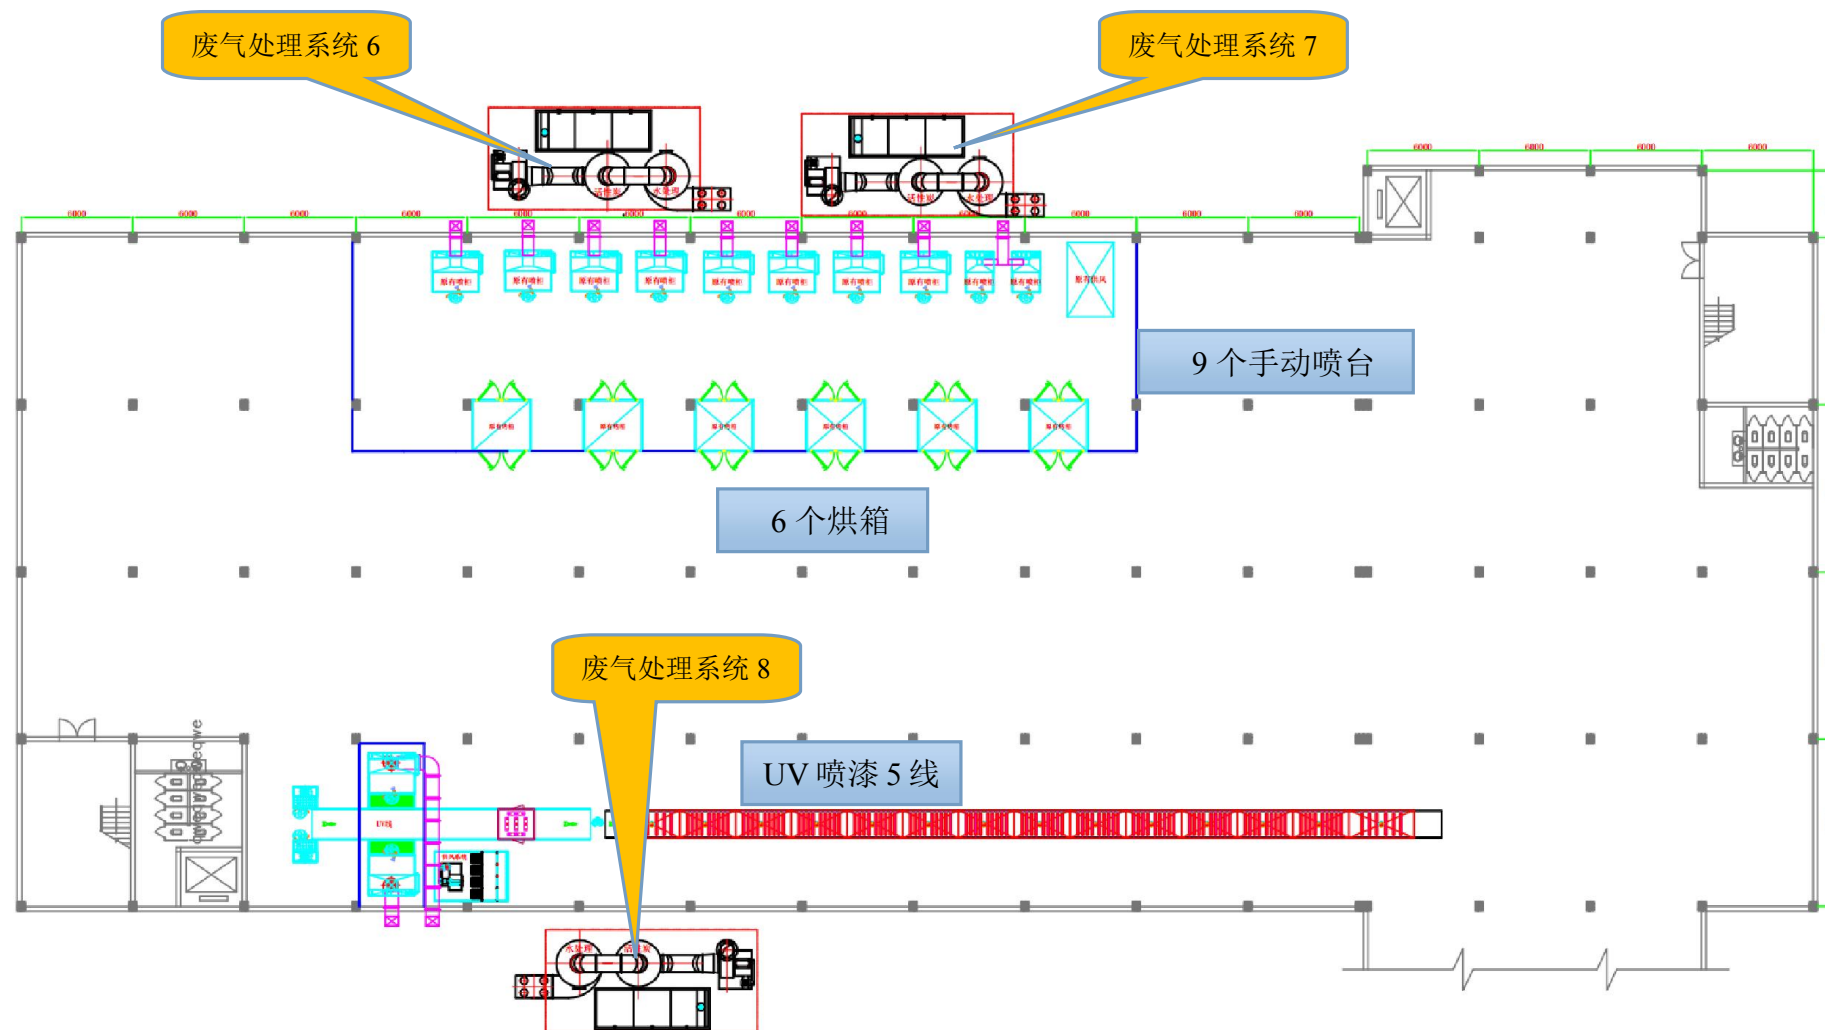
9#楼 3F 喷漆车间平面布置图
